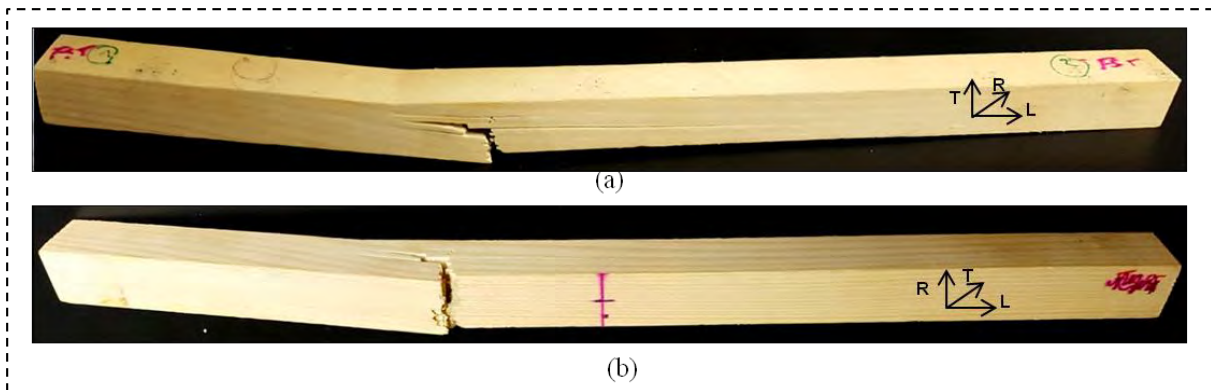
Faciès de rupture de l'éprouvette FS5(a) face avant LT (b) face tendue LR
